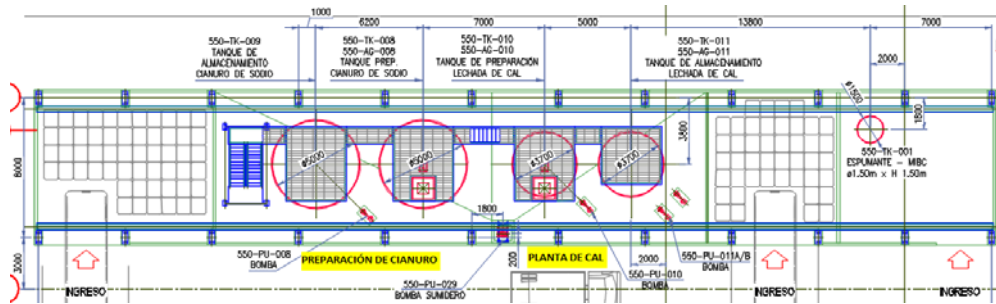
Edificio de Planta de Cal y Preparación de Cianuro
